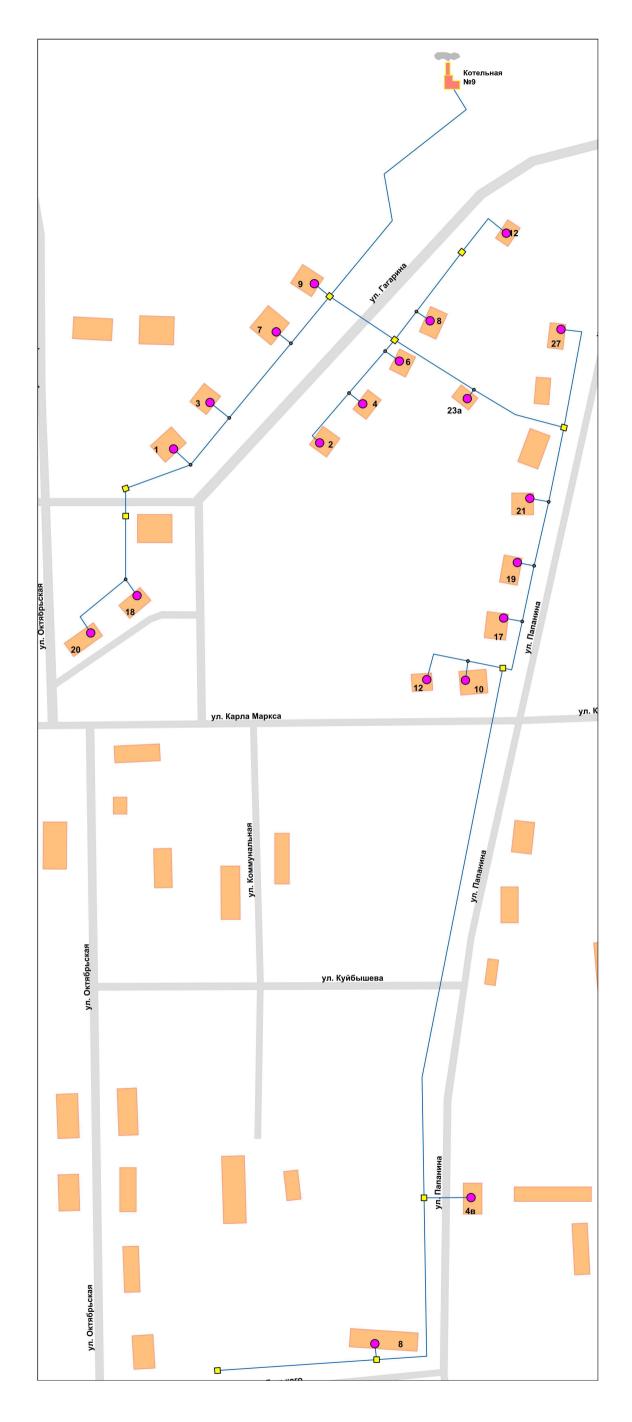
Схема прокладки тепловых сетей от котельной №9.
